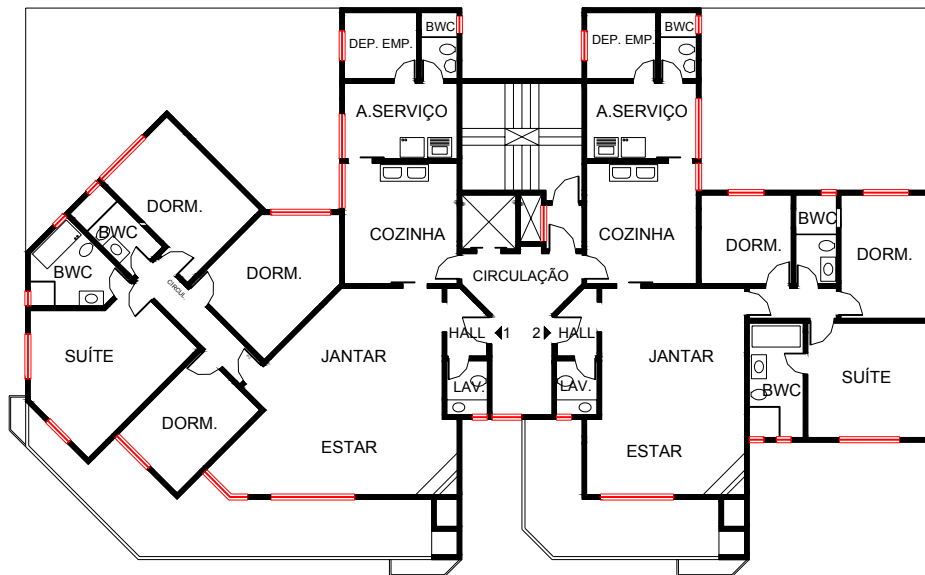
Planta Baixa do pavimento tipo (2º ao 7º pavimentos) do Estudo de caso C.
